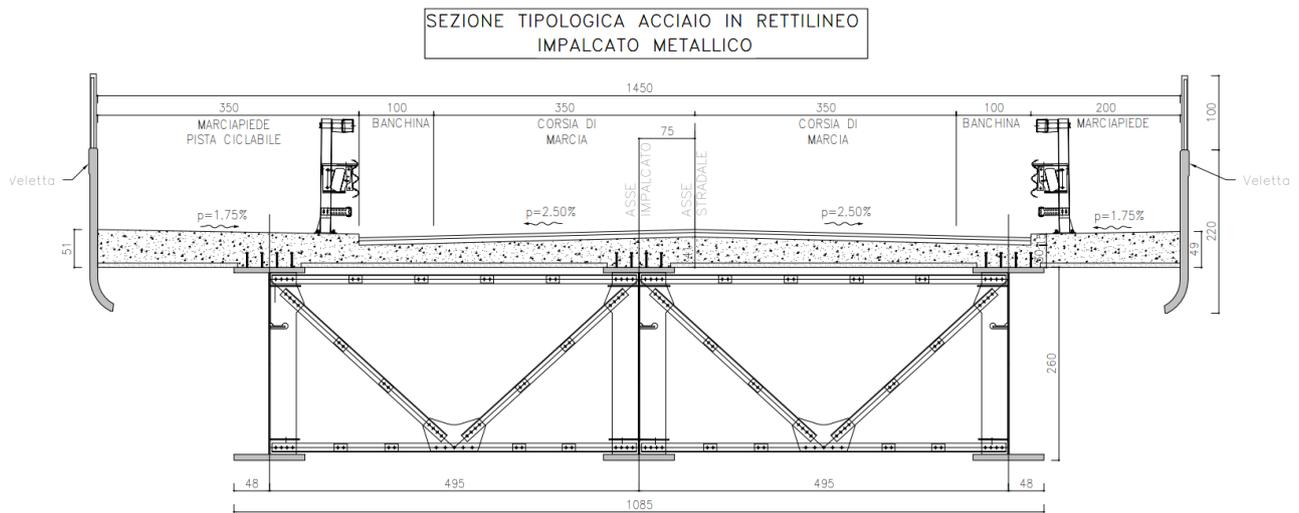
Sezione tipologica dell'impalcato a struttura mista
